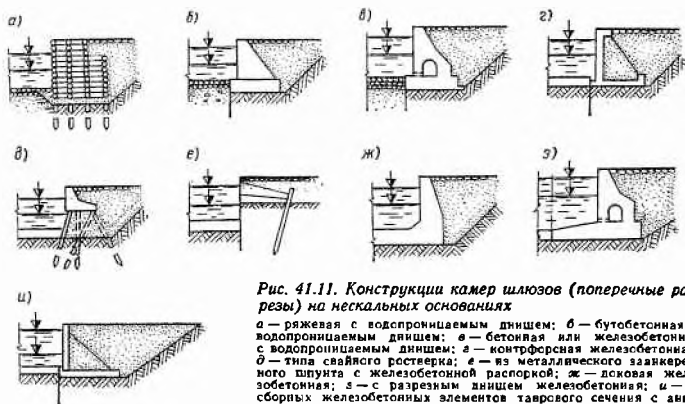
Конструкции камер шлюзов (поперечные разрезы) на нескальных основаниях
